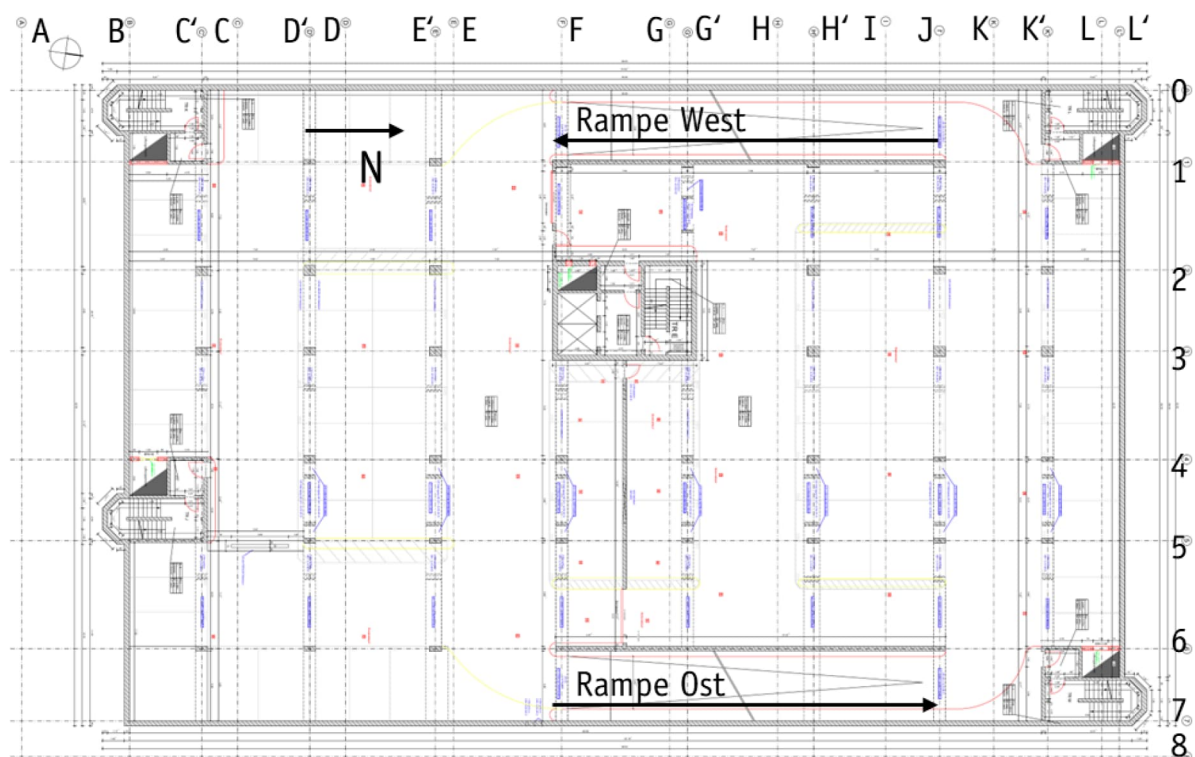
Grundriss des 2. UG der Tiefgarage [U17]. Rampe West & Ost zusätzlich gekennzeichnet.
